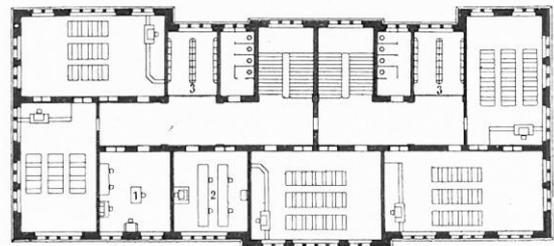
Plan du premier étage. Echelle : 1/500.
